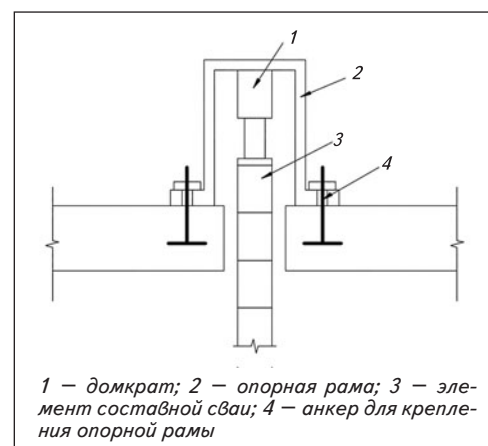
Схема задавливания составных свай через отверстия в фундаментной плите с помощью опорной рамы
